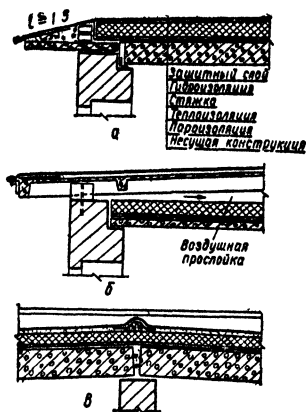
Детали конструкций совмещенных крыш (покрытий) с наружным отводом воды
